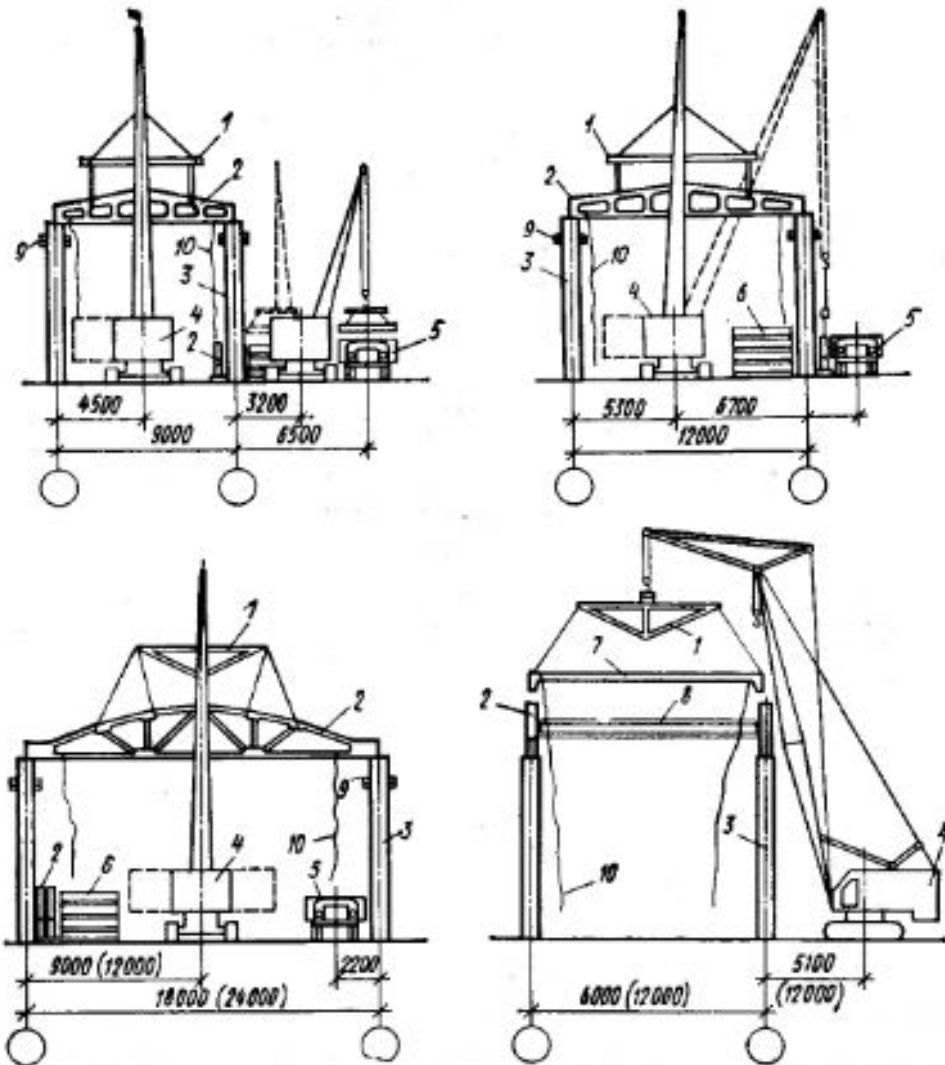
Схемы монтажа фермы пролетом 9, 12, 18 и 24 м и плиты покрытия продольным методом:
